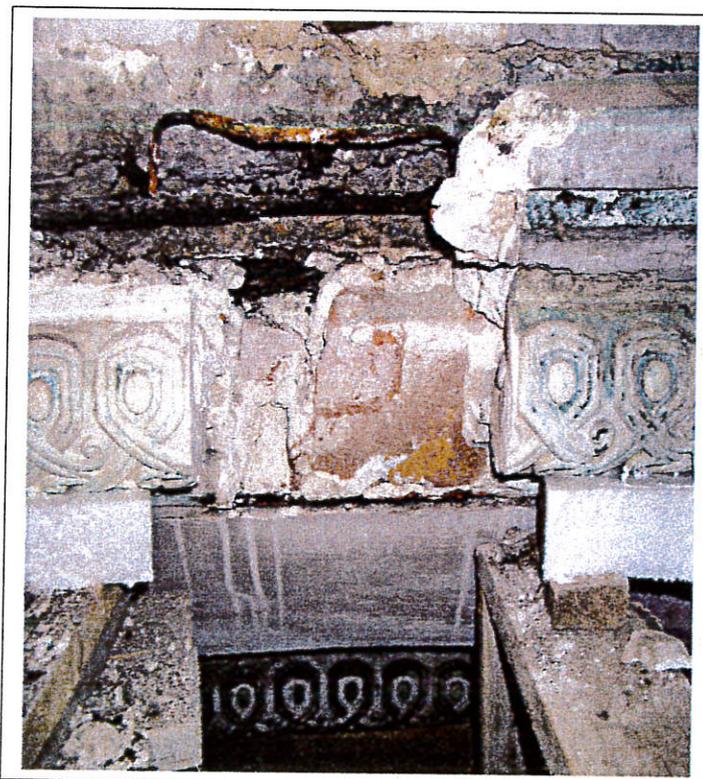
Longherina in ferro della struttura portante della cupola. Si vedono anche, nella parete sotto la longherina, delle colature di acqua piovana che ha danneggiato la struttura.
